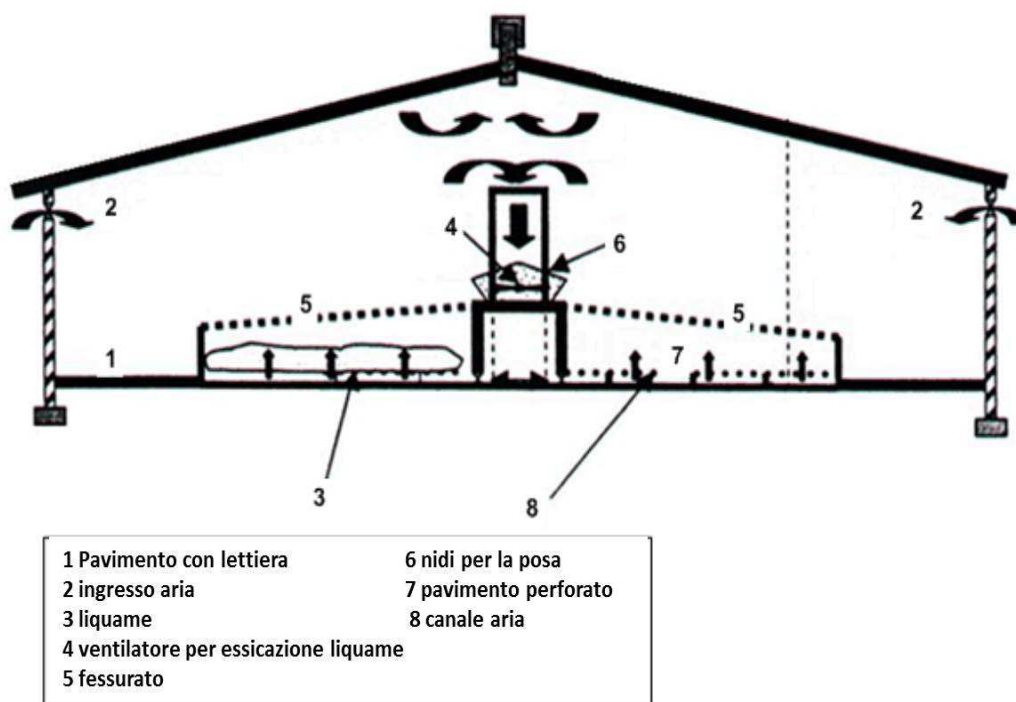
Sistema a lettiera profonda con pavimento fessurato ed essiccazione forzata delle deiezioni
